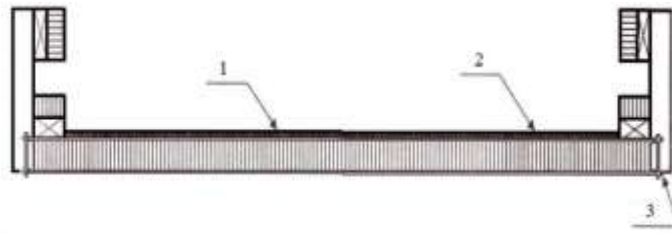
Конструкція плитної прогонової будови з обтиснутої клеєної дерево-плити: 1 – асфальтобетонне покриття; 2 – поздовжня обтиснута дерево-плита; 3 – напружений стержень
